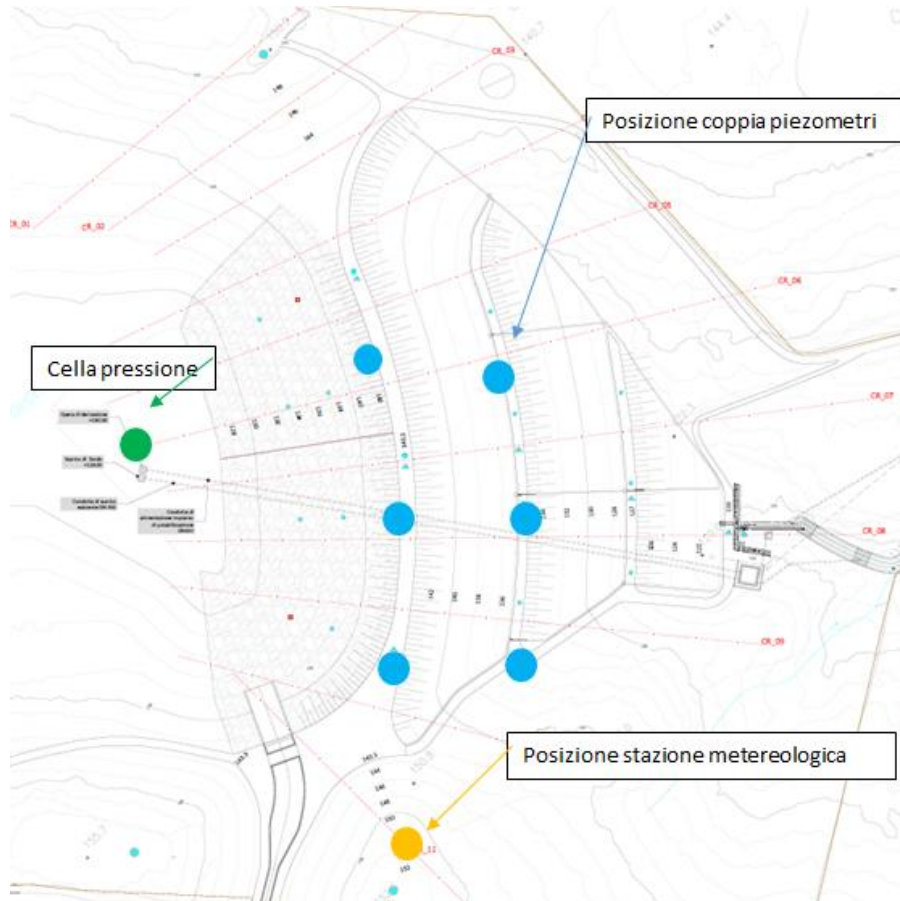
Planimetria ubicazione piezometri corpo diga
